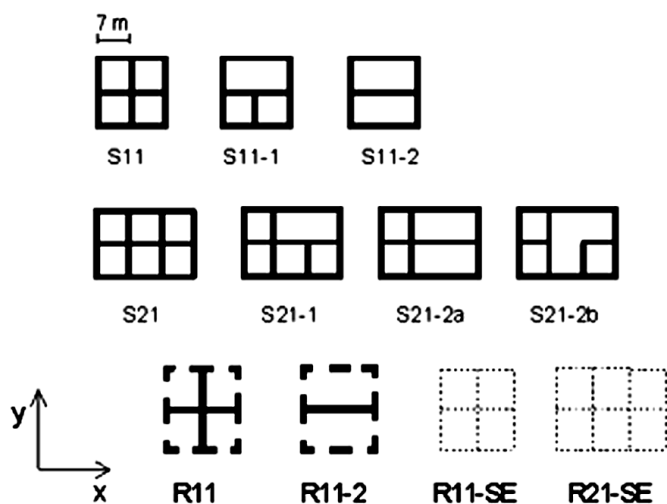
Pianta schematica dei casi esaminati (Tab. 7.1)
